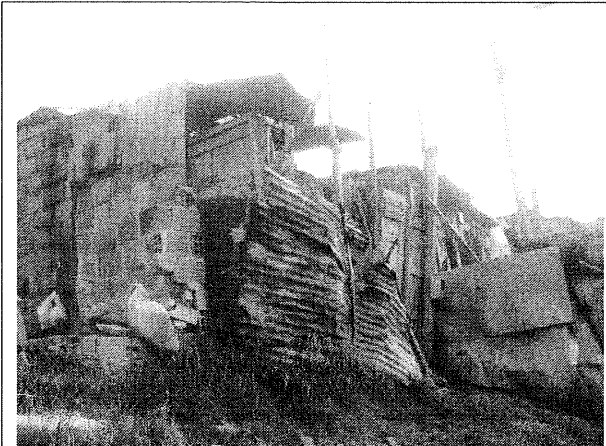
Fachada de la vivienda evaluada. Se evidencia la baja calidad de la construcción y de los elementos que la conforman.
